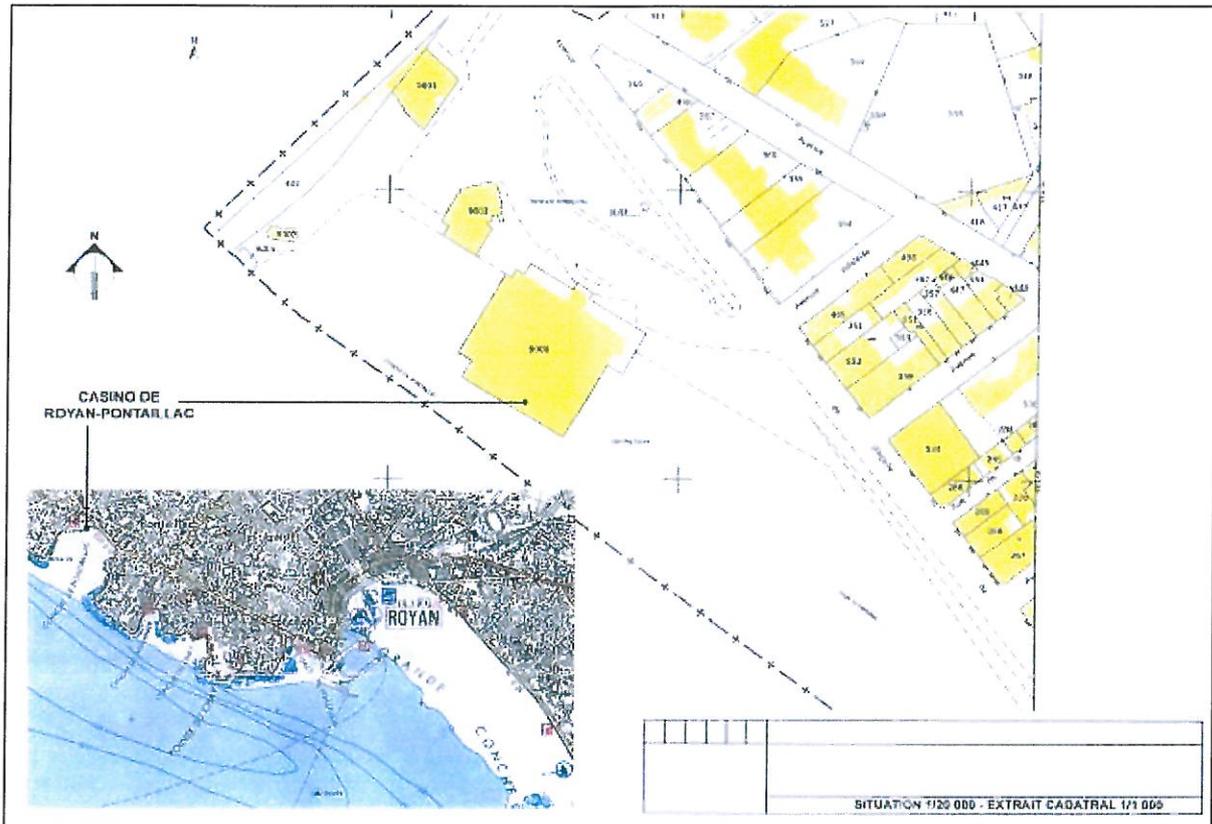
Plan de situation cadastrale du bâtiment associé au Casino de Pontailiac.
